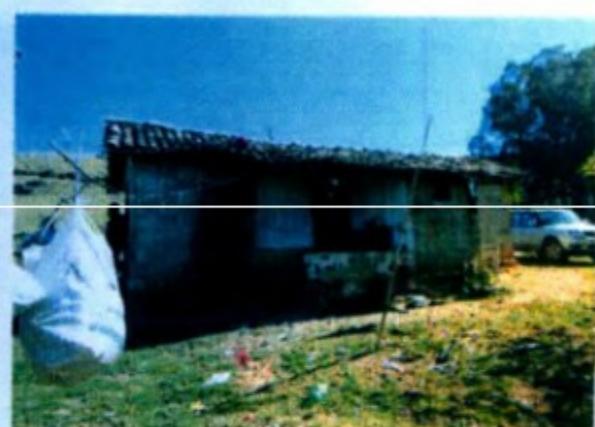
Fachada norte da edificação. Fotografia de 12/09/2017.
